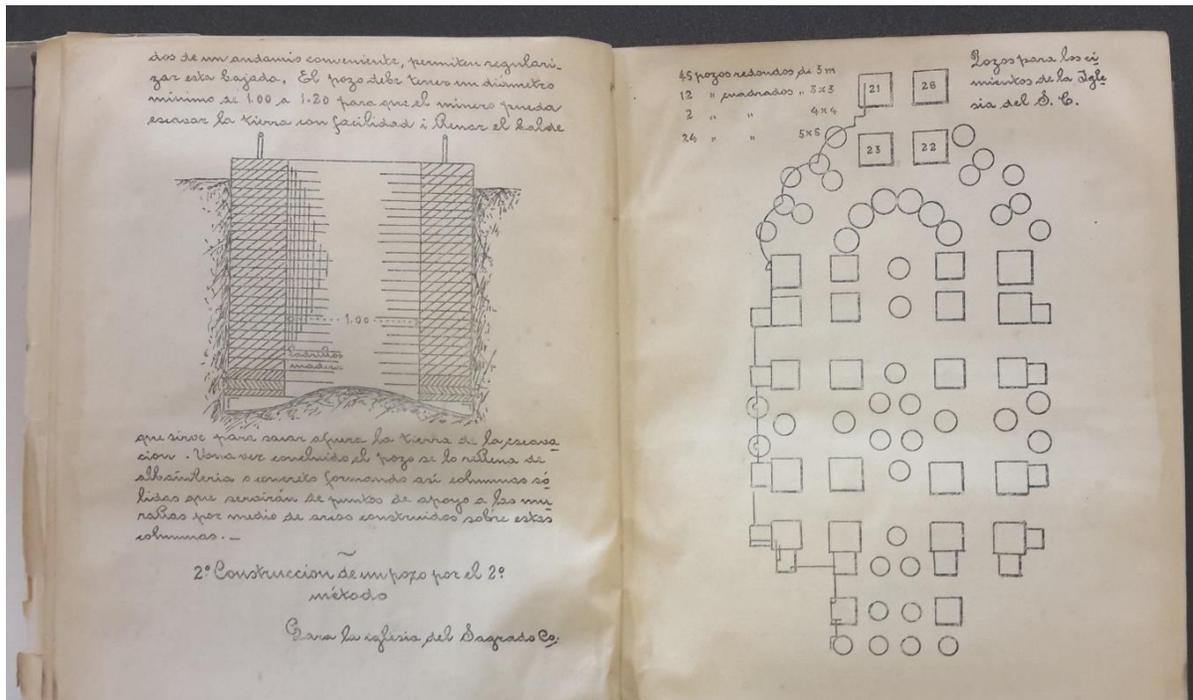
Imagen con esquemas de sección de fundación y planta de la Basílica del Sagrado Corazón de París, del texto "Apuntes del Curso de Construcción", Joannon 1911.
